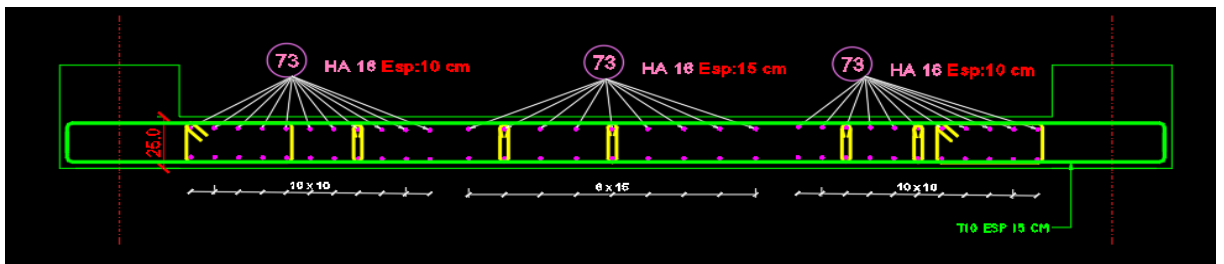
Exemple ferrailage voiles V1-V1'-V1'' de (RDC)
